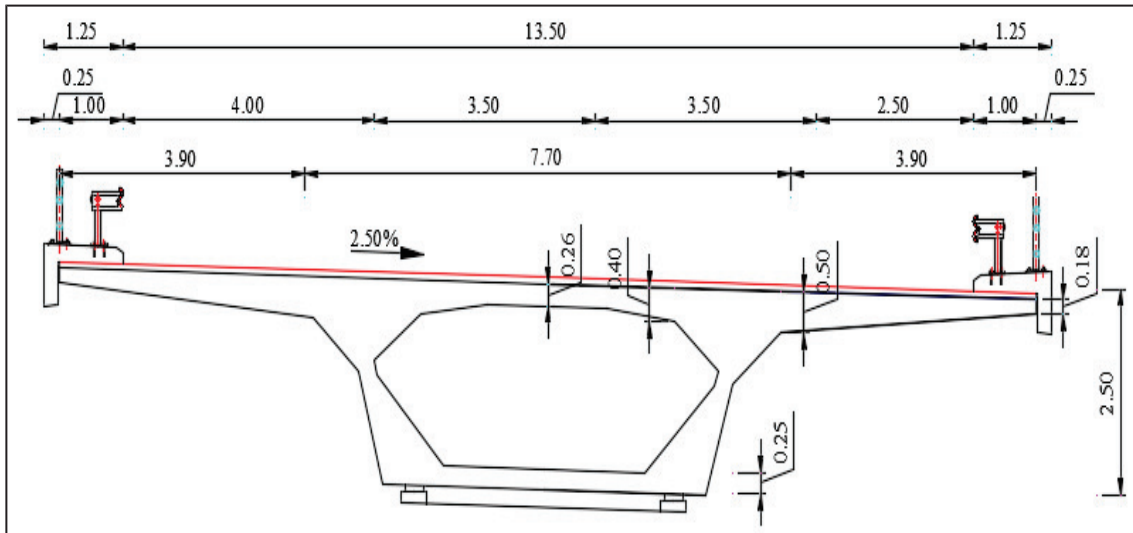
La coupe transversale de la variante Ponts en béton précontraint construits par encorbellements successifs au niveau de mi travée.
